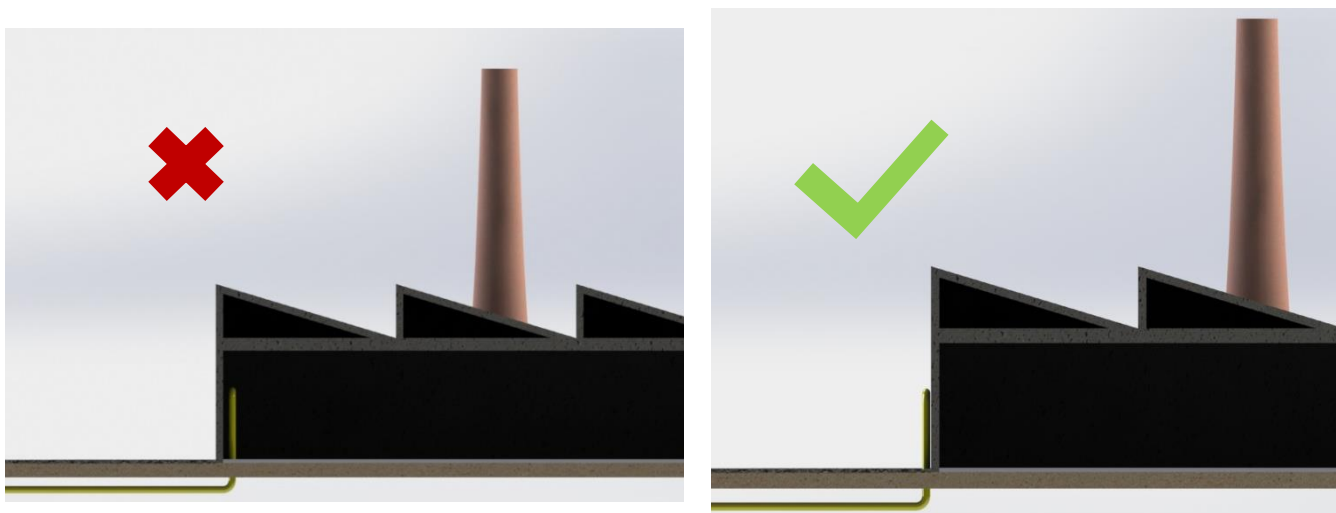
Entrada da tubulação na projeção horizontal da planta industrial
